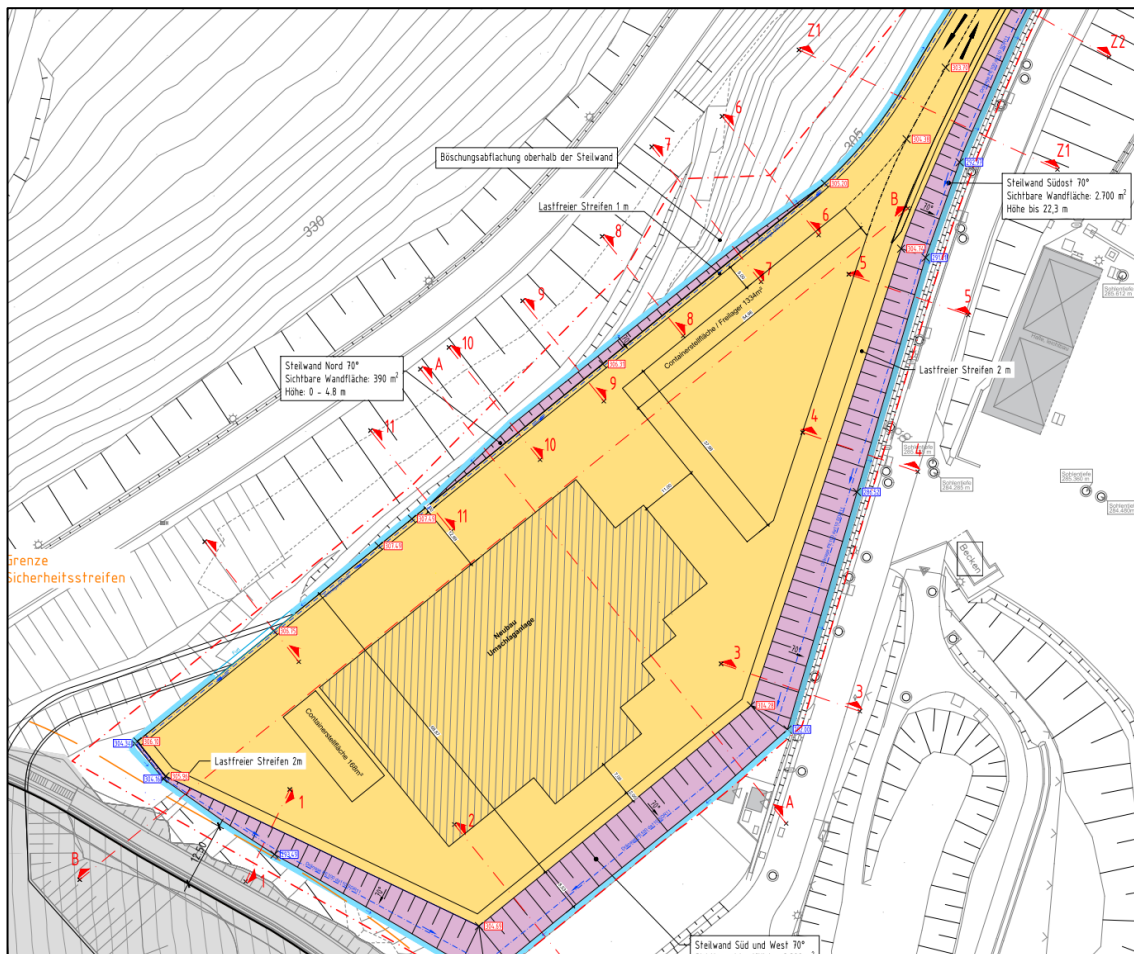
geplanter Plateaubereich mit Umschlaganlage (Ausschnitt aus Plan Nr. 1)
